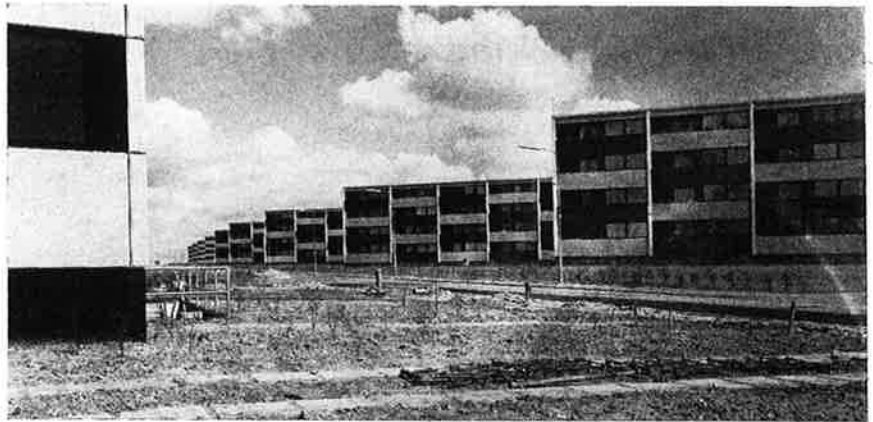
Fasadelement såsom bröstning och överliggare i ett stycke.
